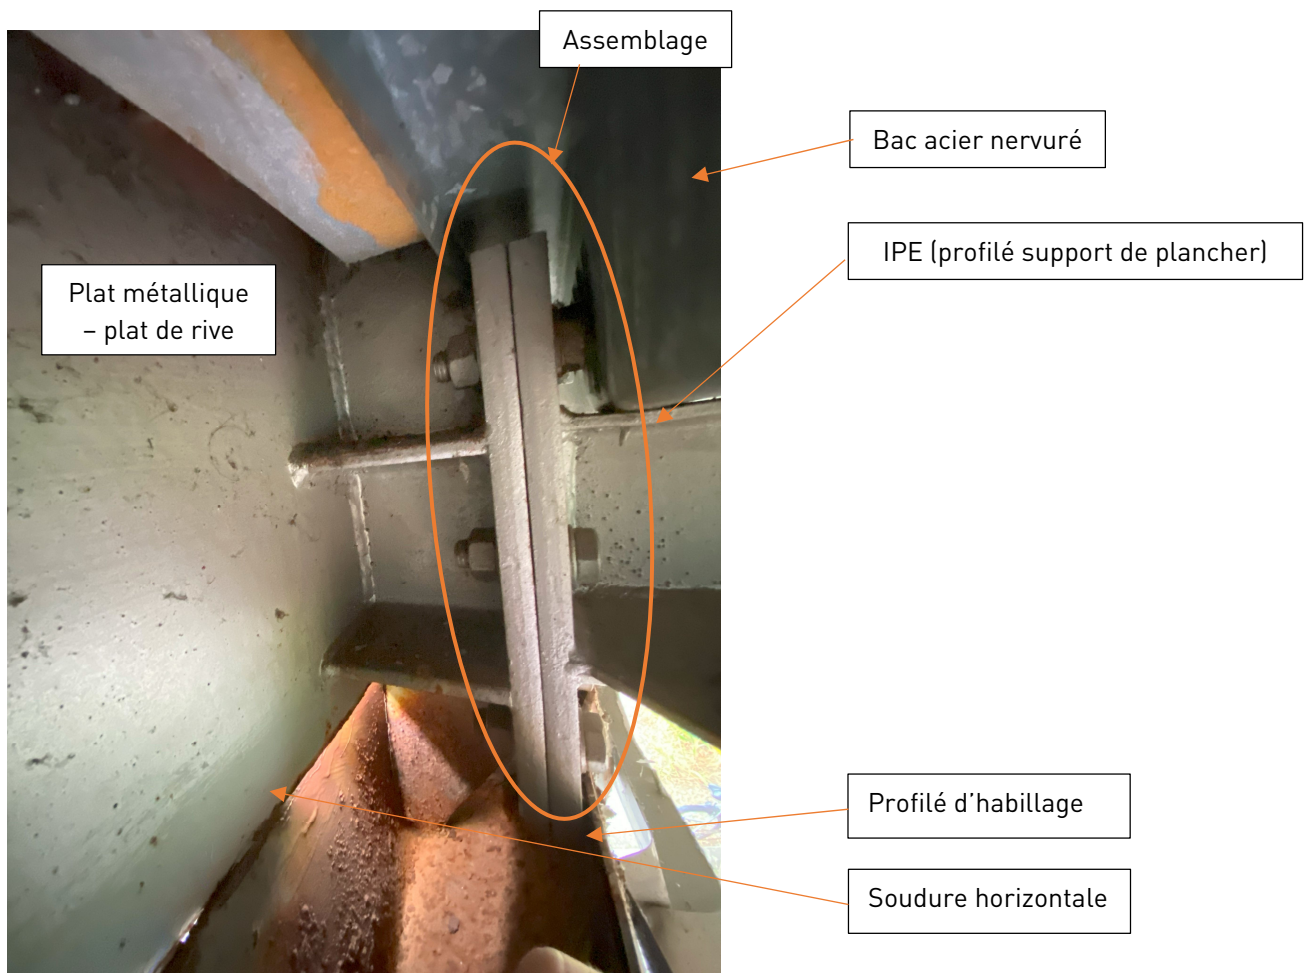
Assemblage du profilé IPE sur le plat de rive
